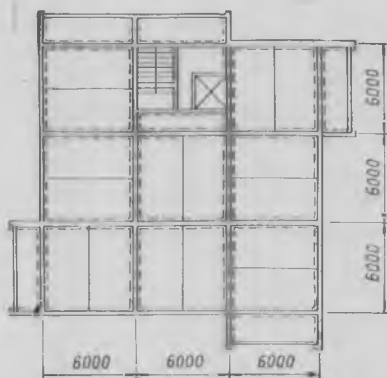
Монтажный план перекрытий сейсмостойкого крупнопанельного 9-этажного дома серии А-1-451-КП
